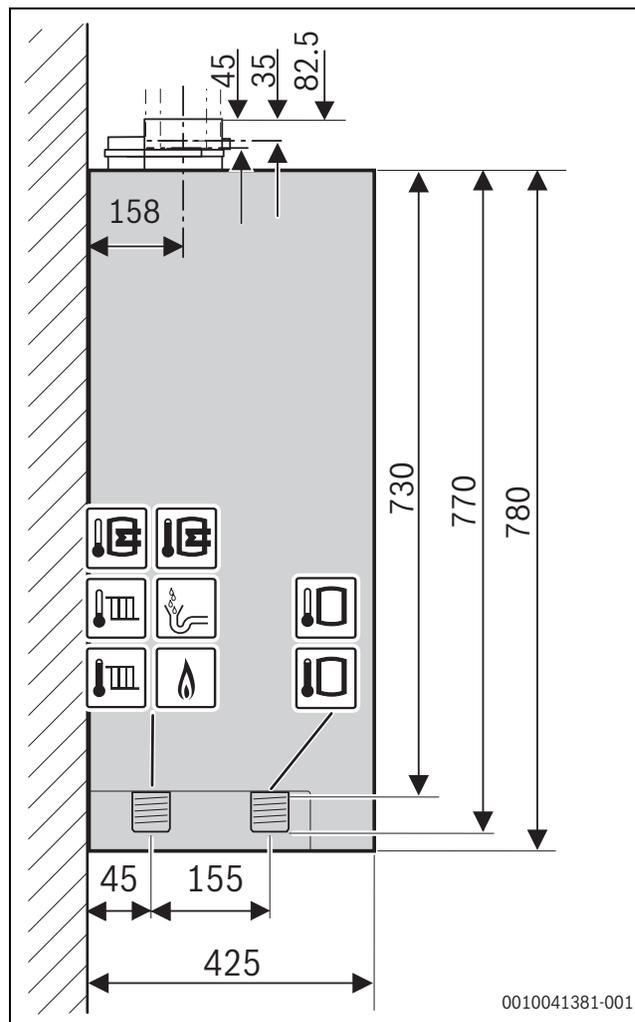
Seitenansicht GB(H)192i.2 15-25-35kW (mm)
